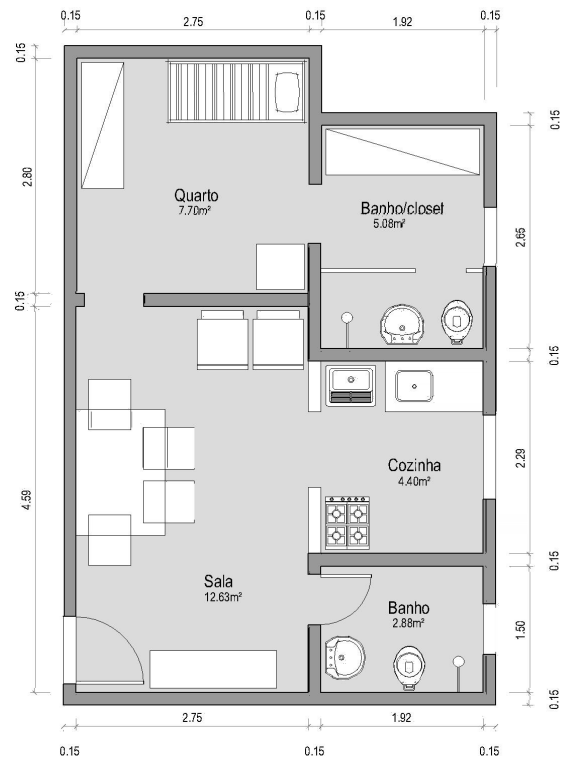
Planta baixa da casa de Sr. Rodrigo. Área construída: 32,64m<sup>2</sup>.
